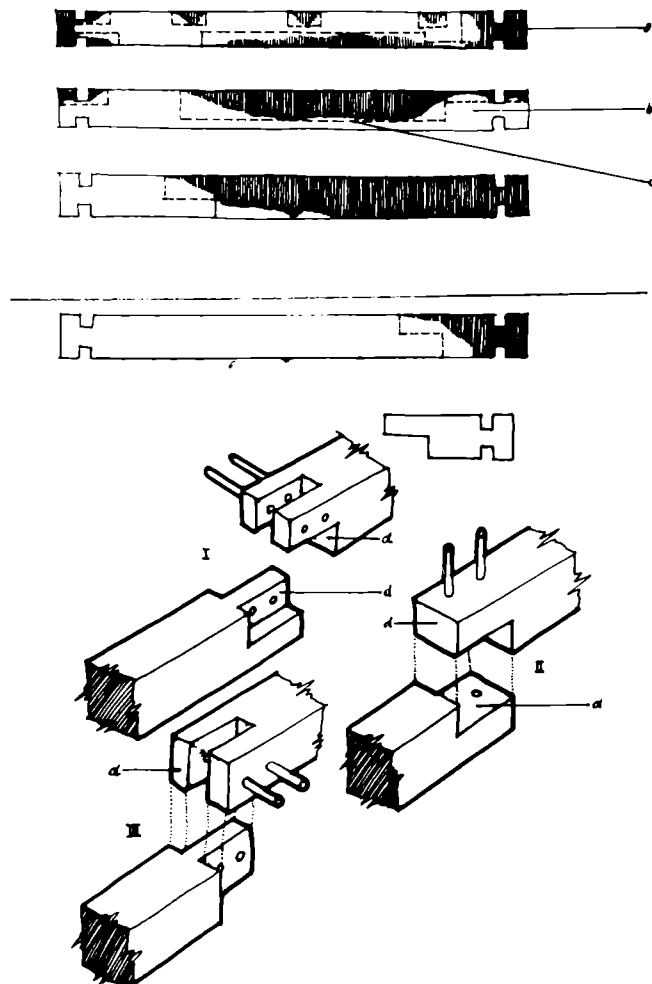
Înlocuiri în secțiuni longitudinale, la elemente de construcție
